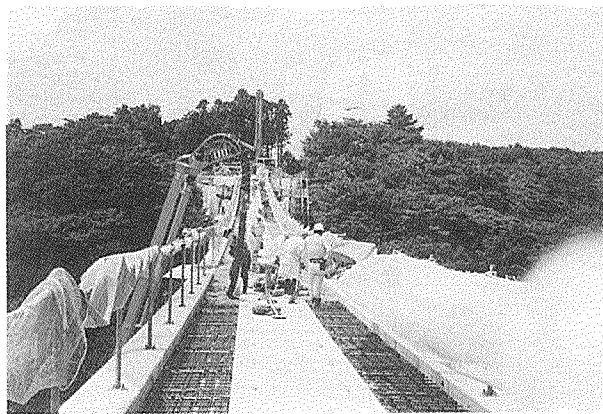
プレキャスト版場所打ち部コンクリート打設状況
